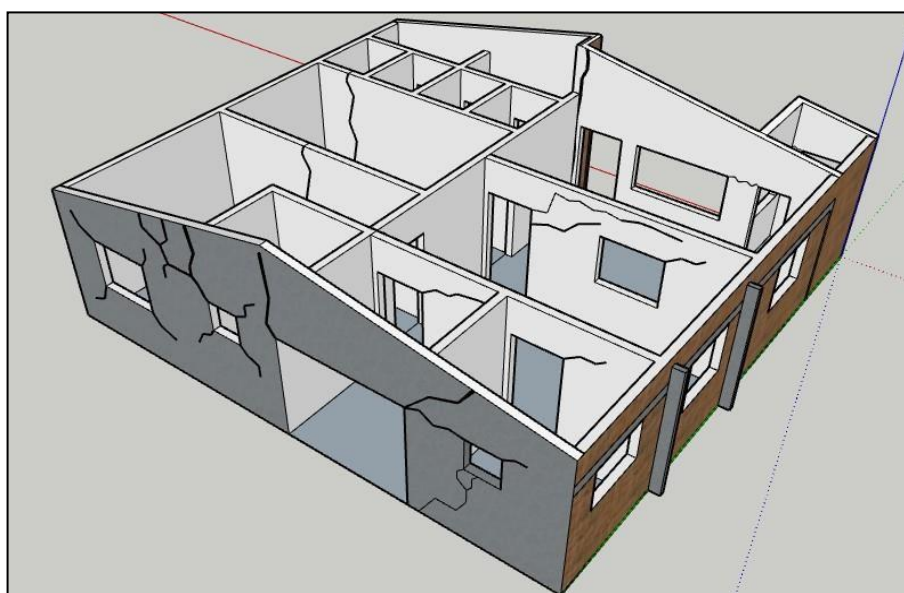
Configurações típicas de fissuras causadas por recalques de fundações
